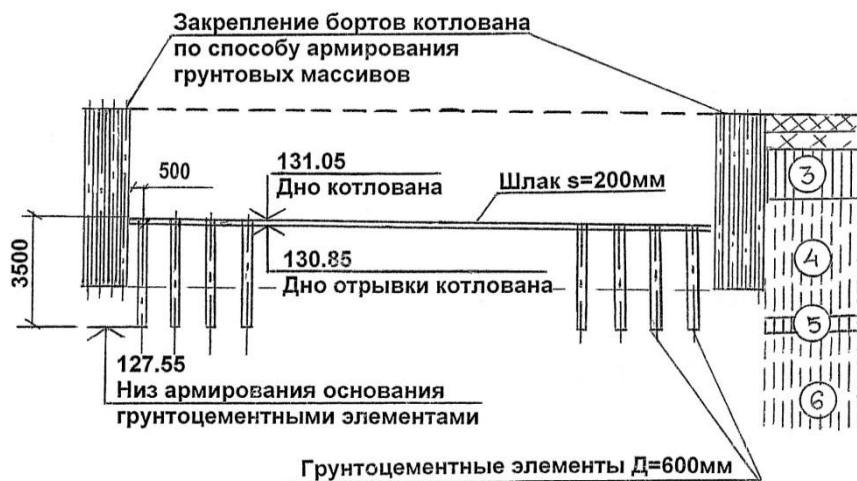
Схема выполнения работ по закреплению бортов котлована и основания плитного фундамента.
